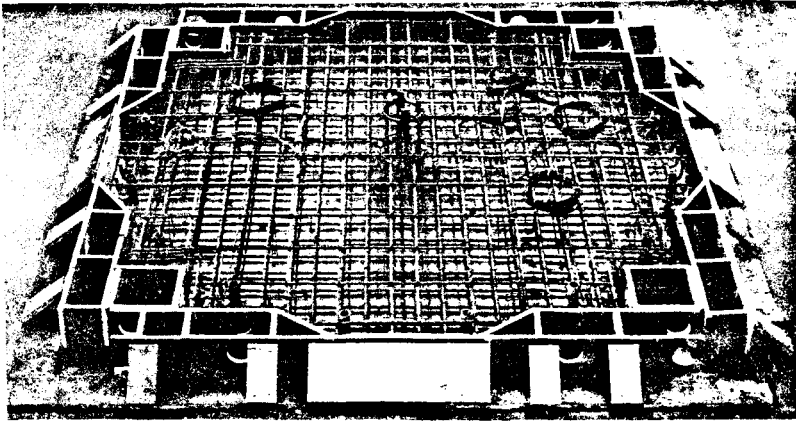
Versuchskörper V5 (ohne Vorspannung) vor dem Betonieren
